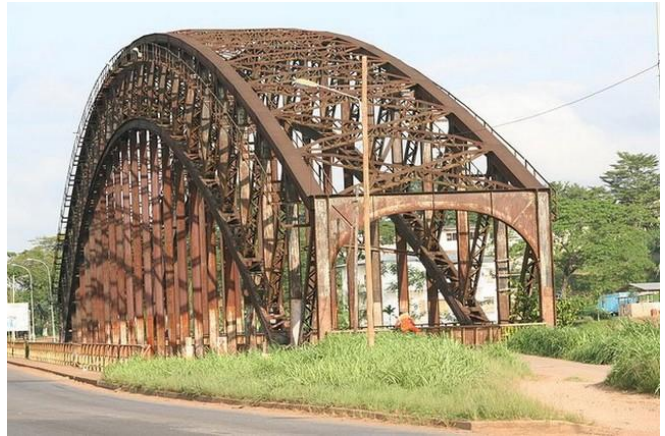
Pont allemand à Édéa construit en 1911 sur le fleuve Sanaga.
